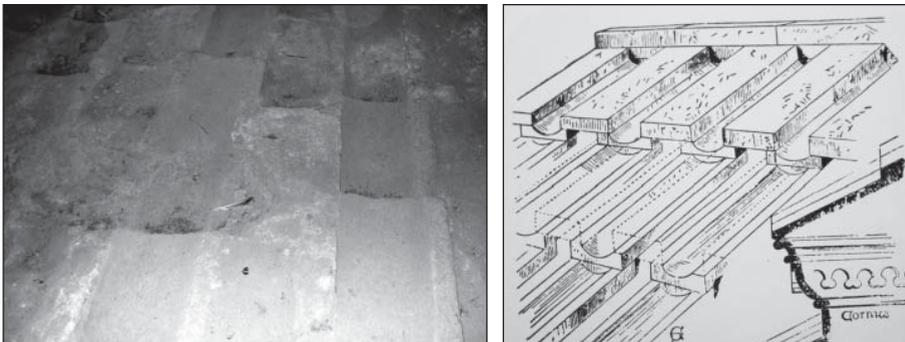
Detalle de las losas de piedra de la antigua cubierta (O. Jewitt, 1865).
